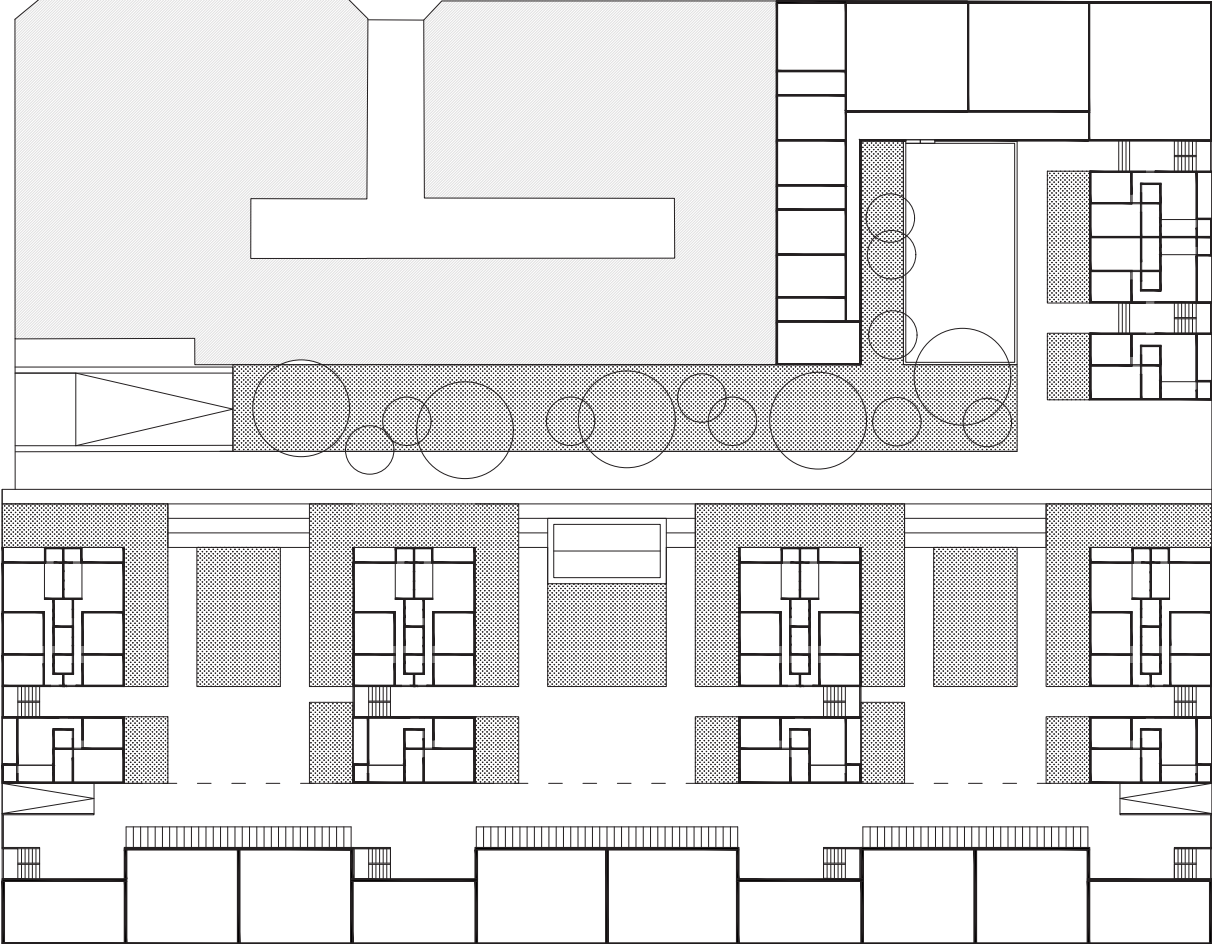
Planta general primera planta, sin escala y norte arriba. FUENTE: Elaboración propia.
